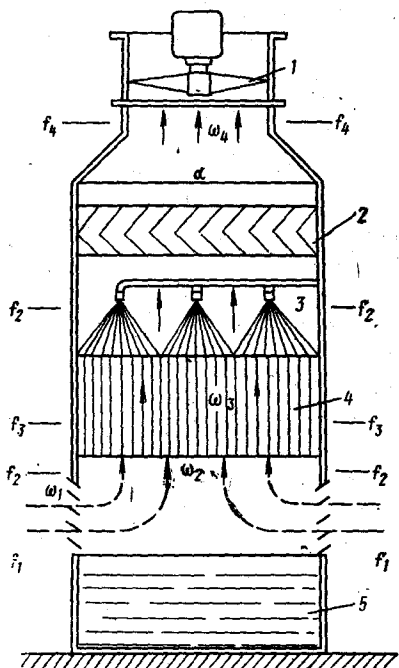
Схема к аэродинамическому расчету вентиляторной градирни:
